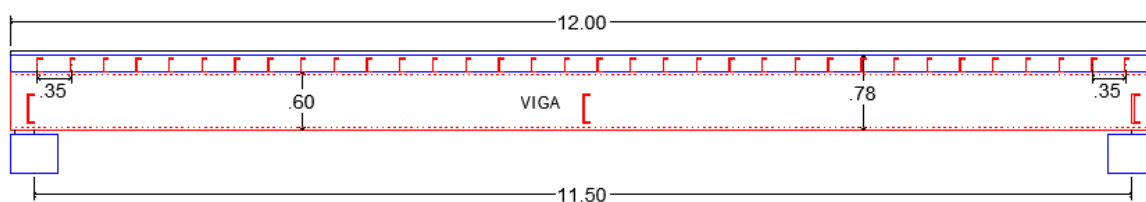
Corte longitudinal de la estructura del puente con vigas metálicas de 12 metros. (ver anexo 04 página 02)
